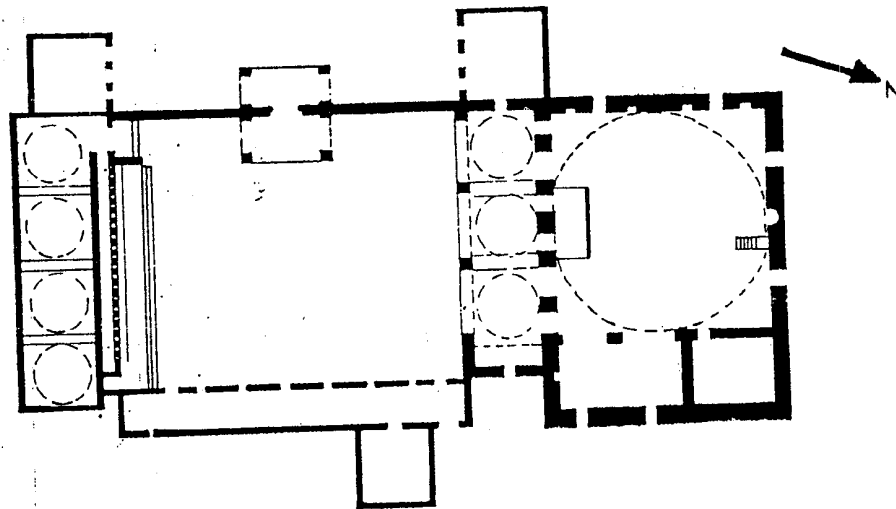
مسقط أفقي لزاوية الدمرداش بالعباسية (عن : Abouseif)
